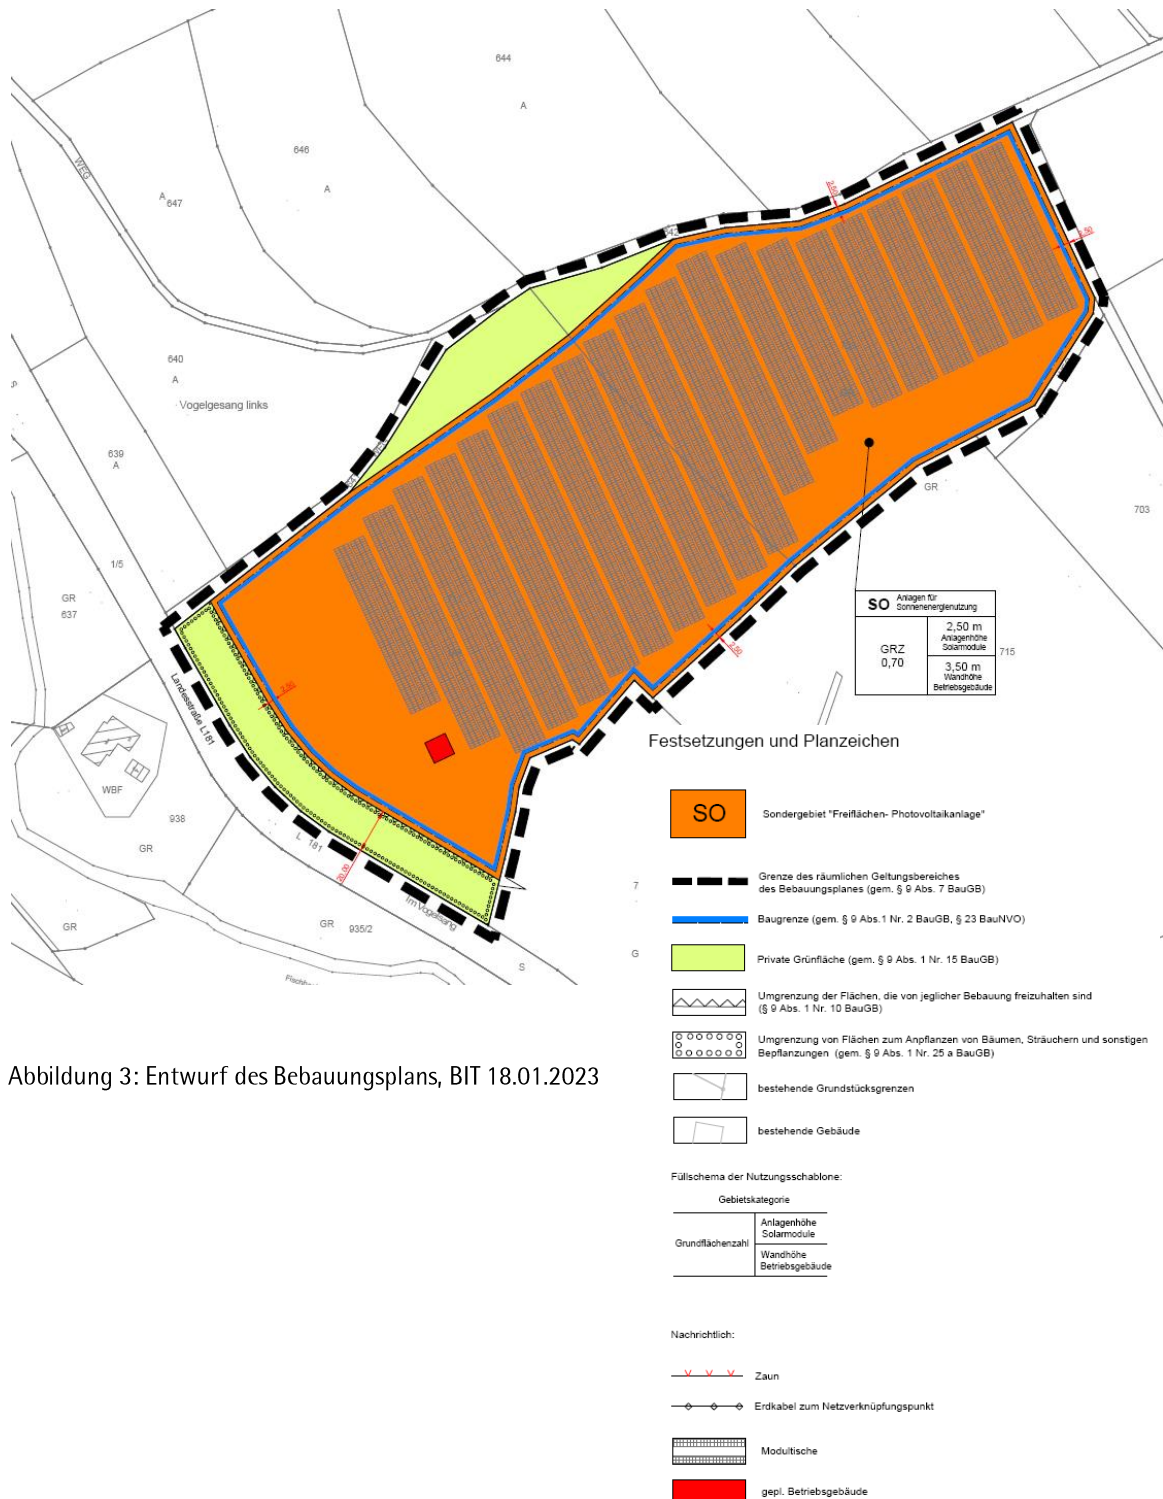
Entwurf des Bebauungsplans, BIT 18.01.2023
